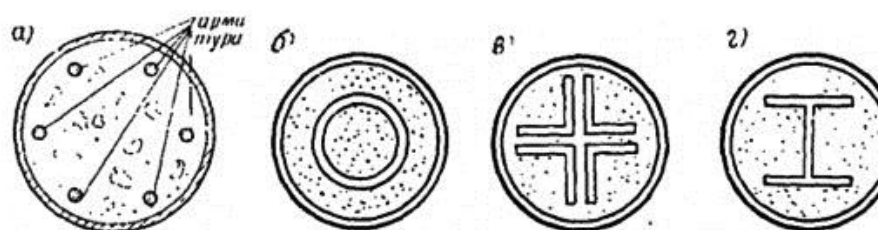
Армирование бетонного ядра: а – гибкой арматурой; б – жесткой арматурой в виде трубы; в – то же, уголком; г – то же, двутавром
